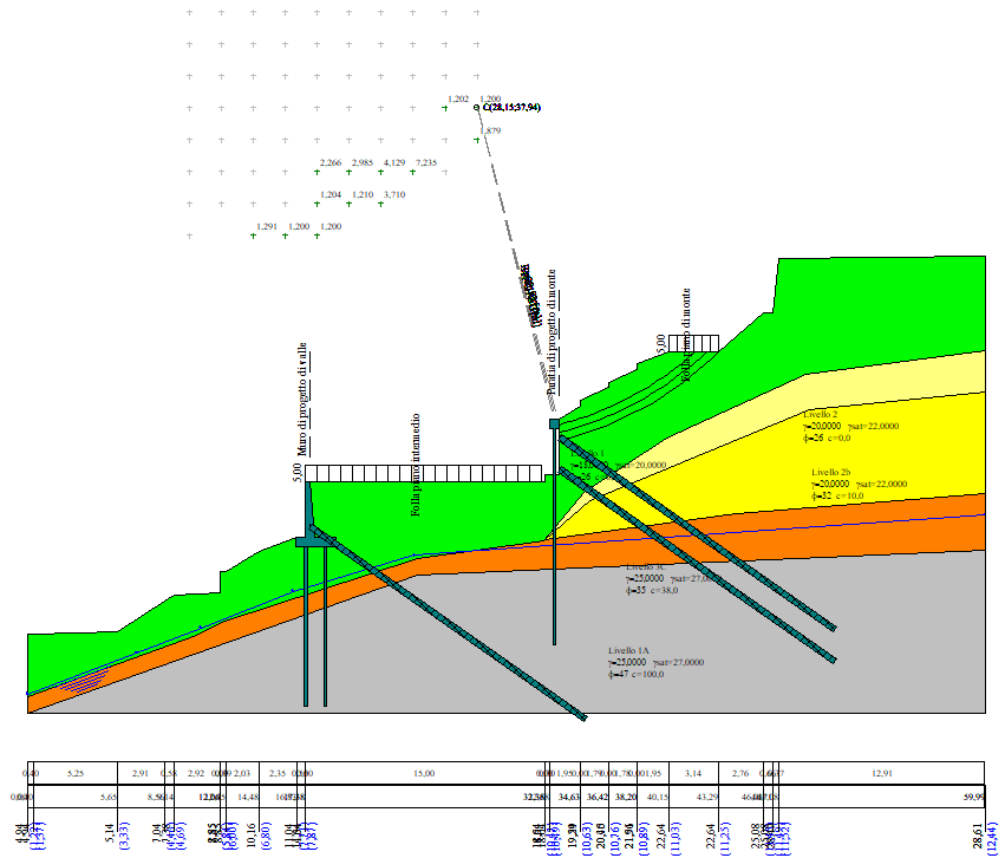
Sezione 8 di progetto. FS minimo 1.200
